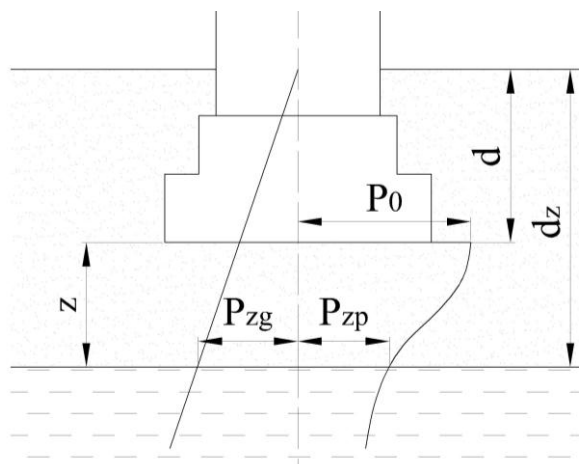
Расчетная схема фундамента при наличии слабого подстилающего слоя
